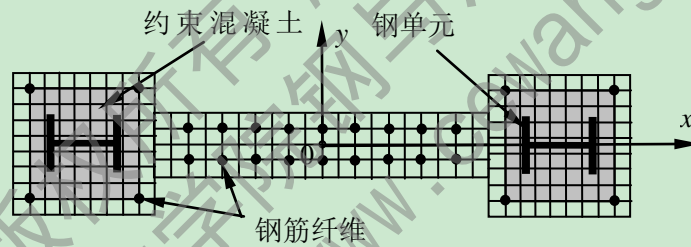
型钢混凝土剪力墙截面尺寸及配筋
